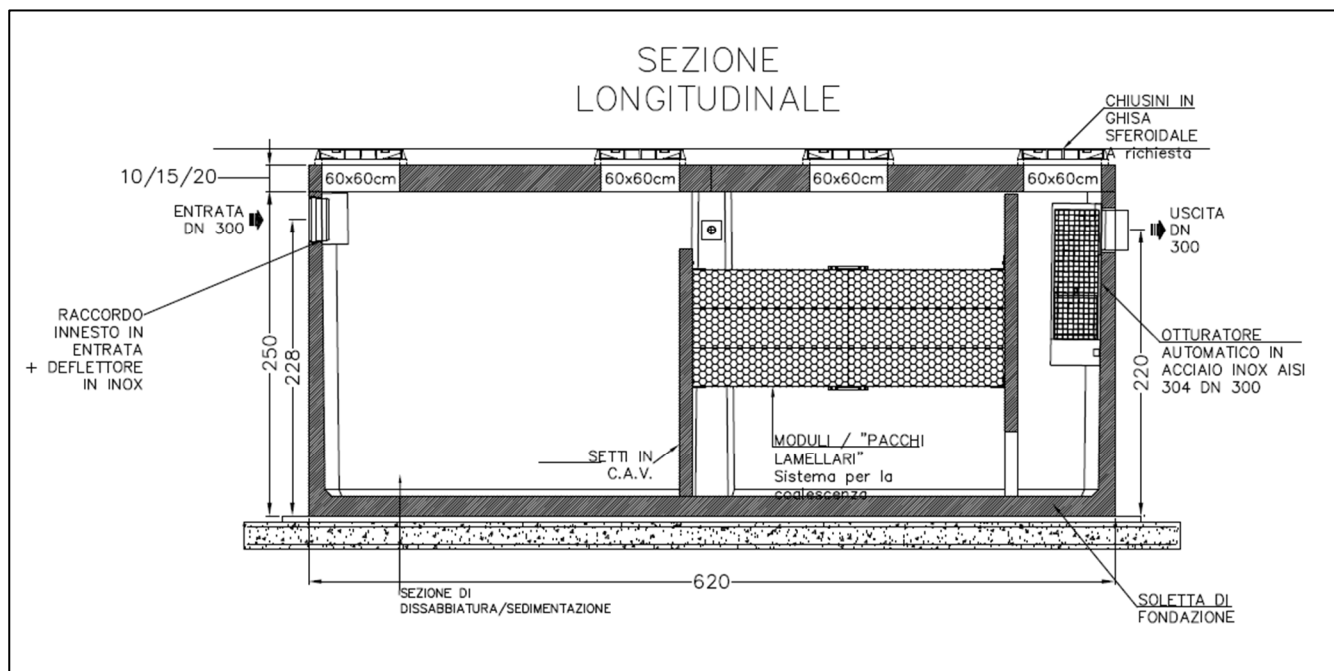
Sezione longitudinale impianto di dissabbiatura/dissoliazione
